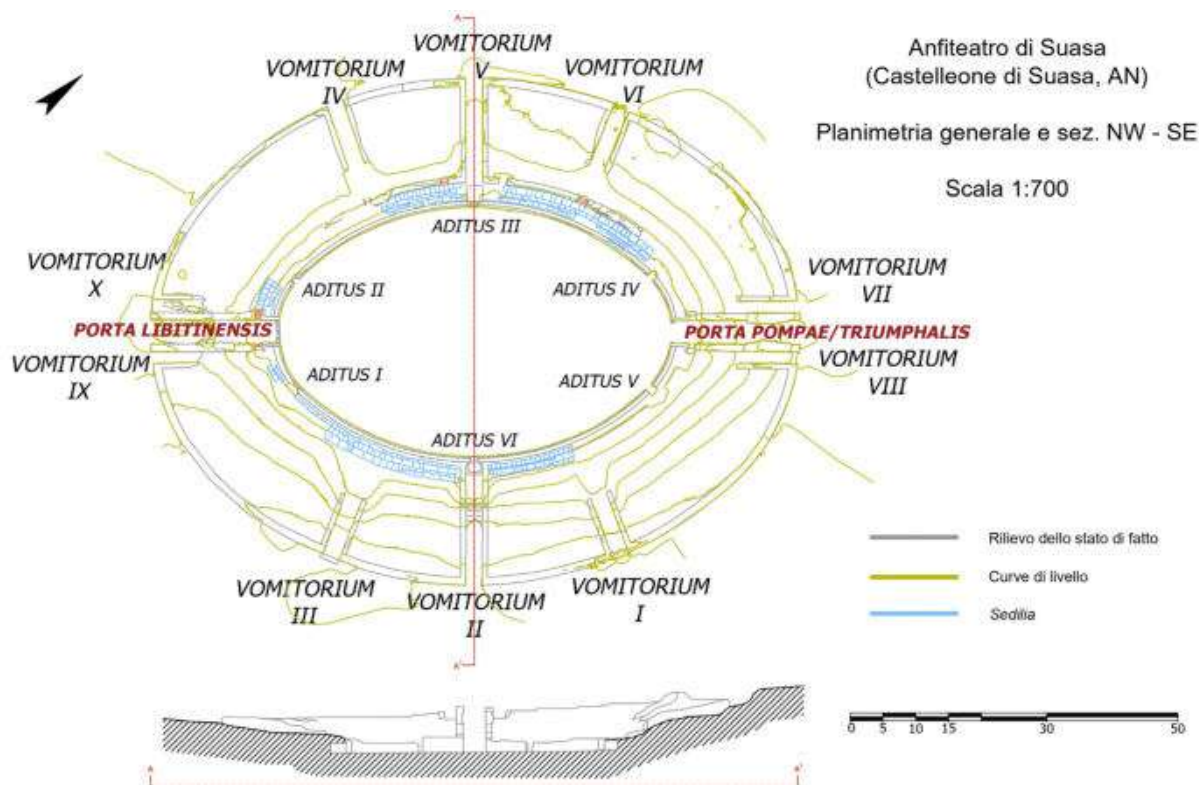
Planimetria e sezione NW-SE dello stato attuale dell'anfiteatro di Suasa (elaborazione e rilievi A. Campedelli e F. Bindelli).
